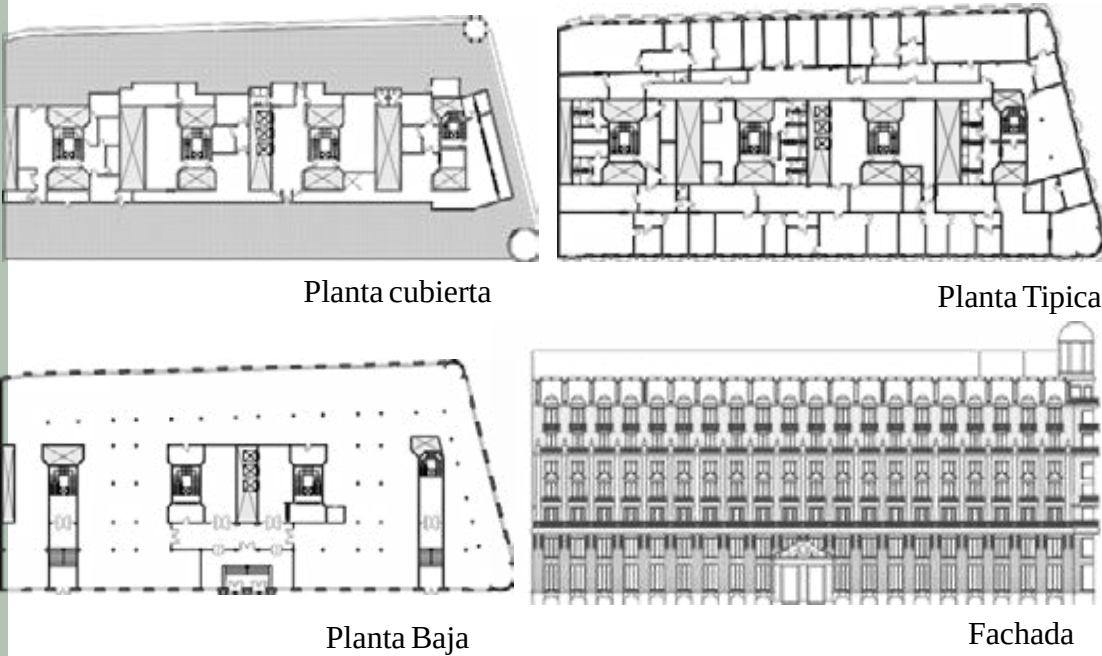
Planos arquitectónicos Edificio BSH a intervenir. Fuente: Archmedium
